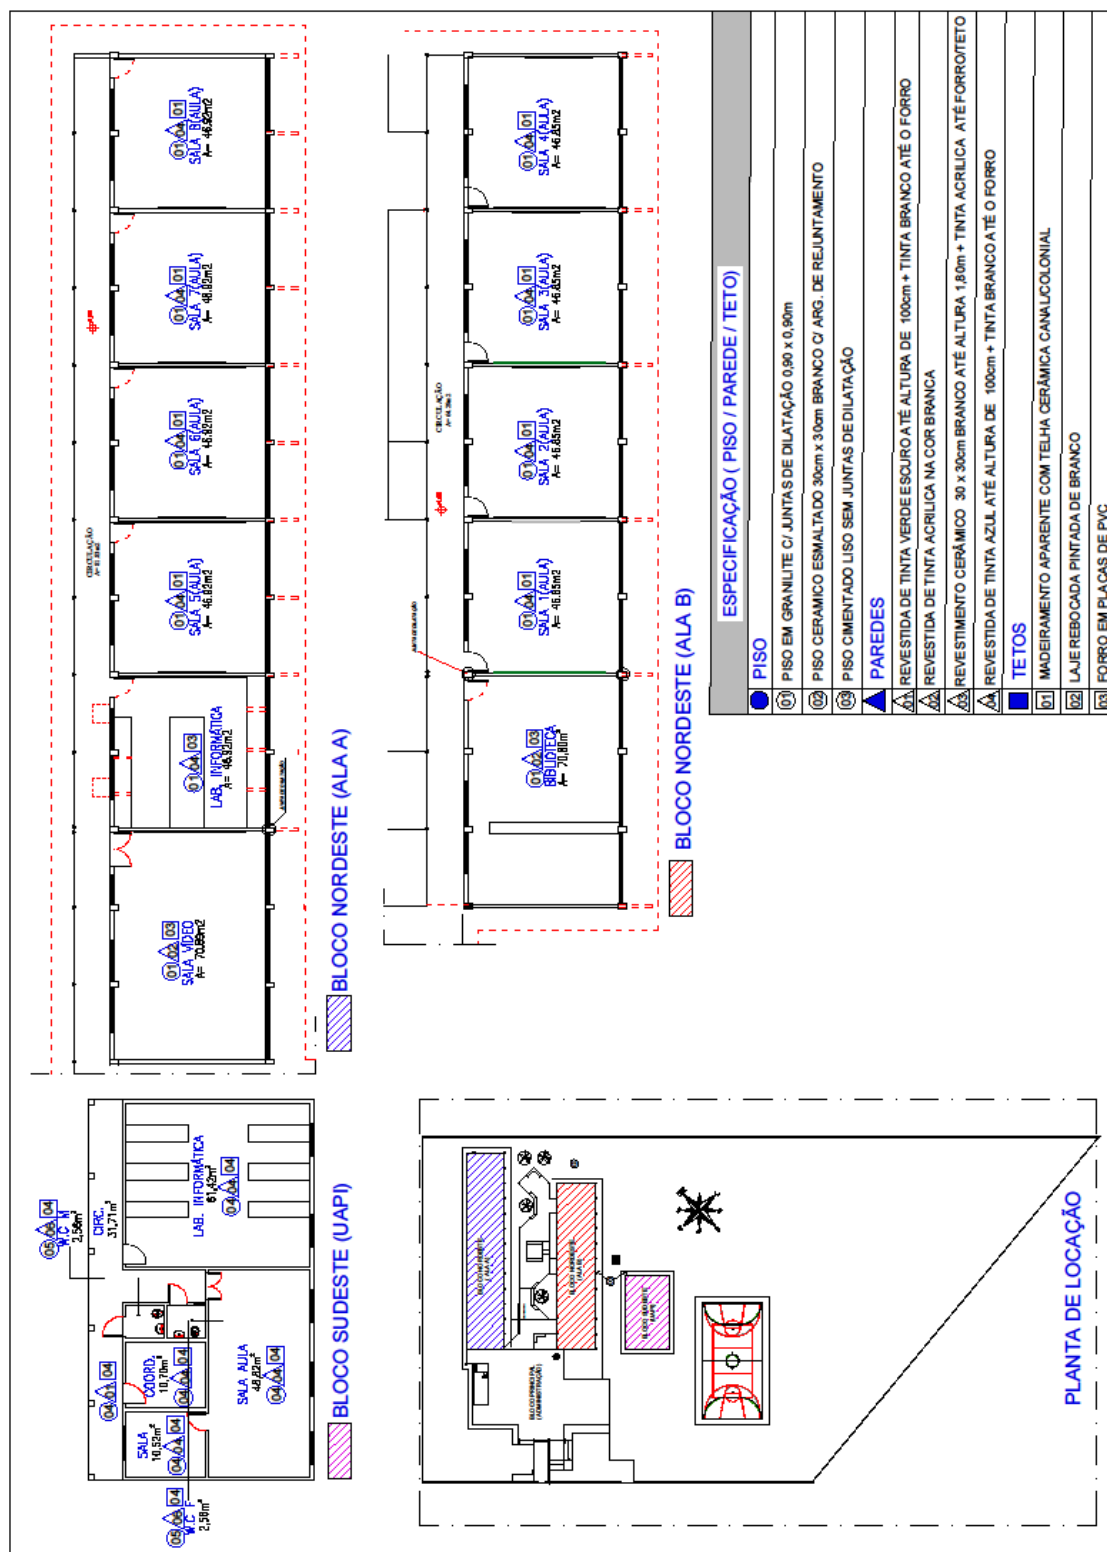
PLANTA BAIXA BLOCO NORDESTE E SUDESTE
